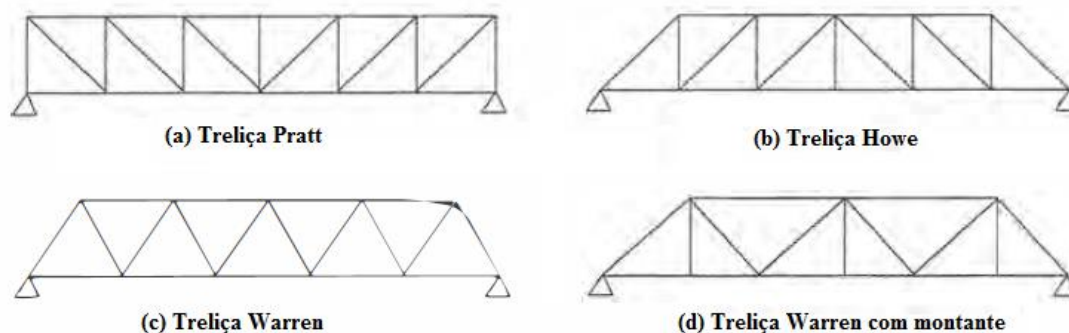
Tipos de vigas treliçadas com bancos paralelos (Adaptado de Pfeil, 2011)
